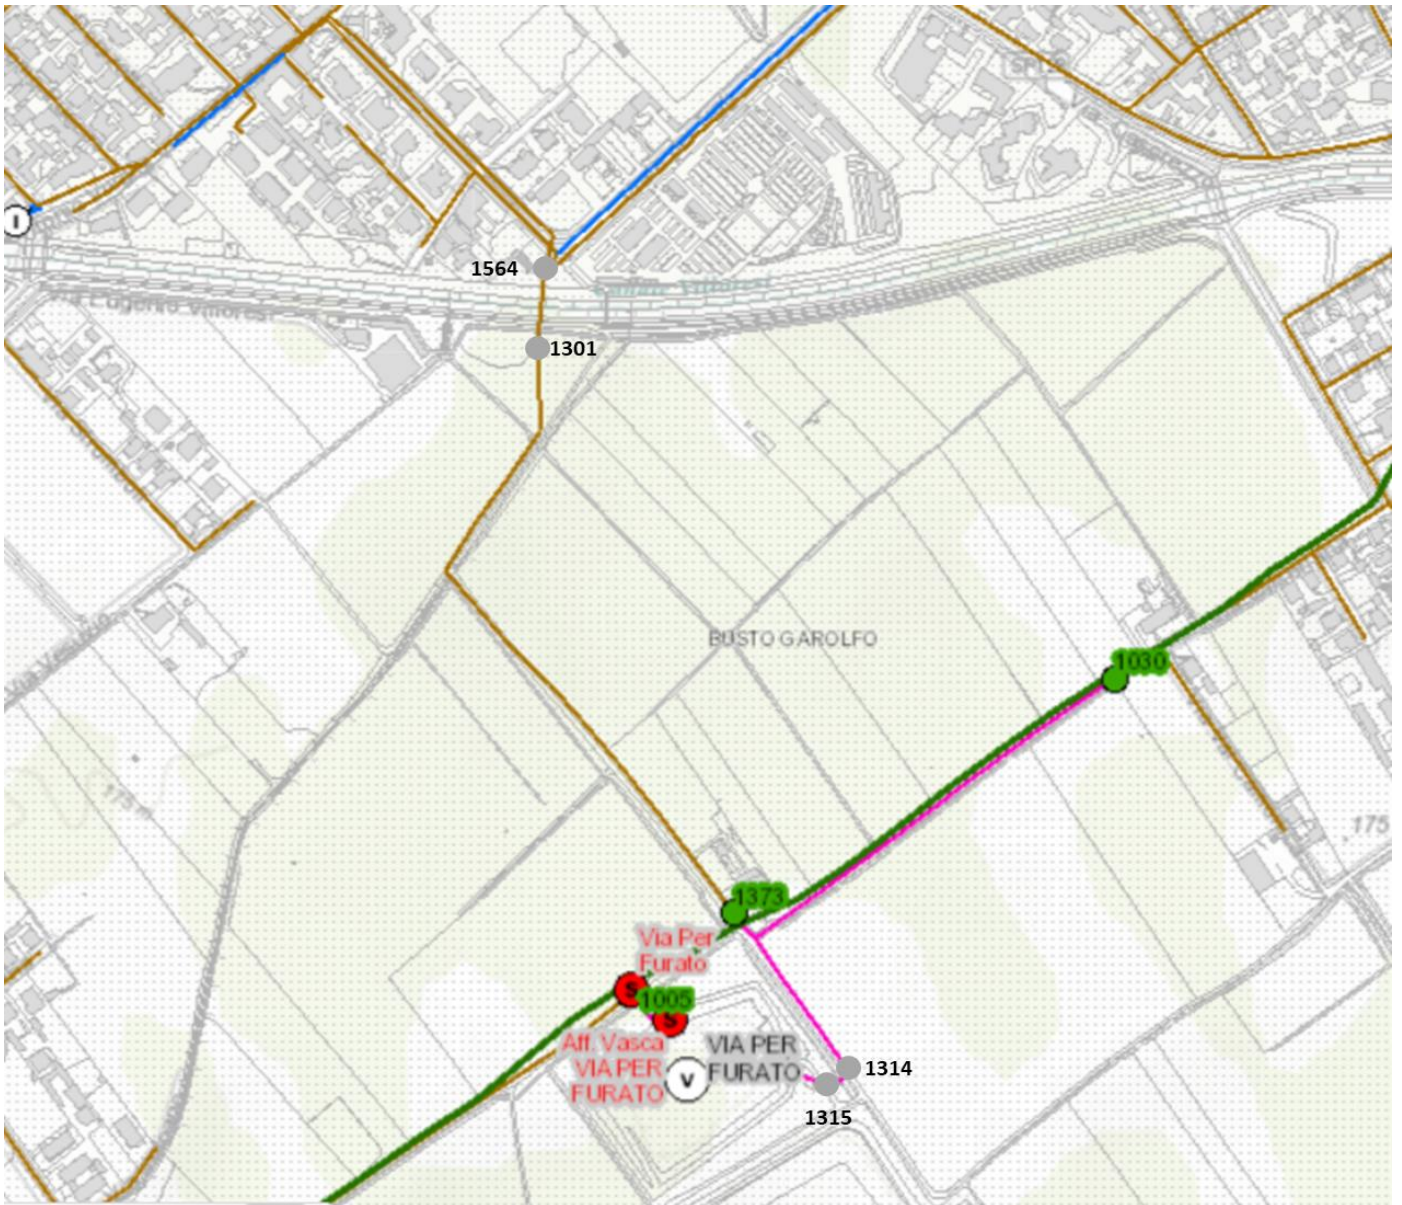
Planimetria collettore a valle dell'attraversamento del canale Villoresi, oggetto di potenziamento
